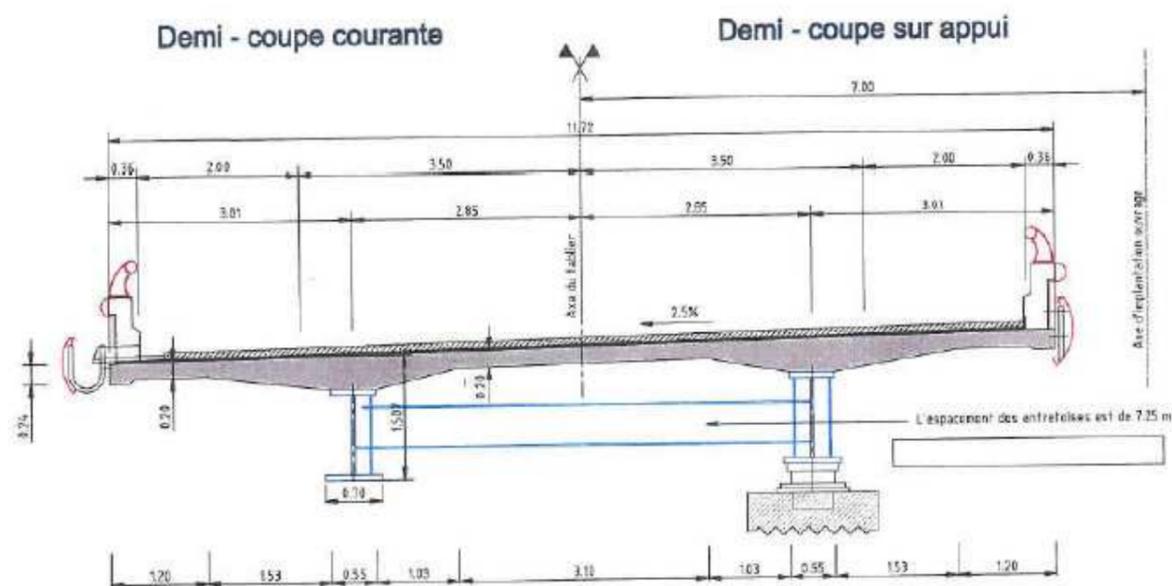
Coupe transversale du tablier actuel (source EPOA 1999 – SETRA)
